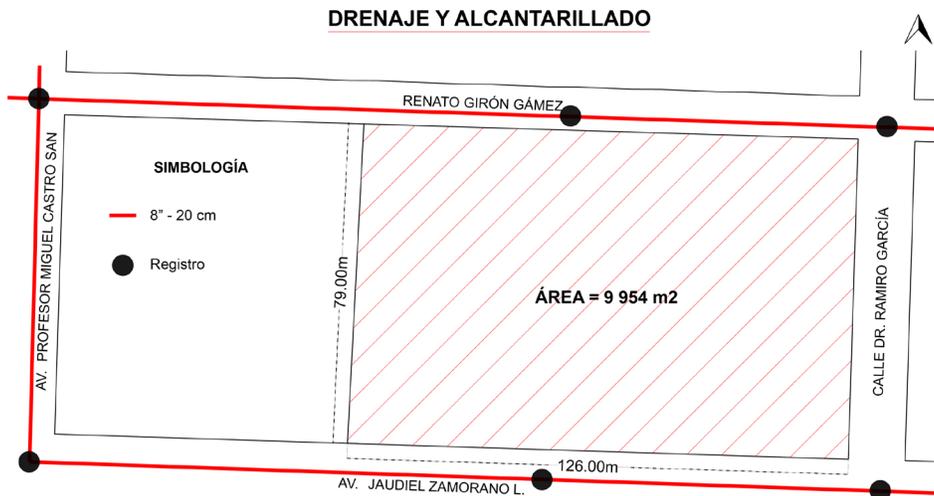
Red de drenaje y alcantarillado. Autoría propia, 2019.
